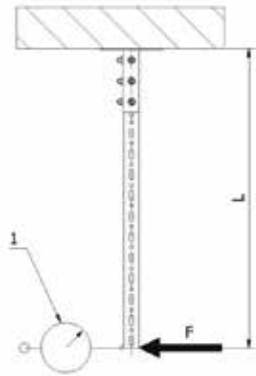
Configurazione di prova per staffa fissata a muro / *Test set-up for a wall fixed cantilever bracket
